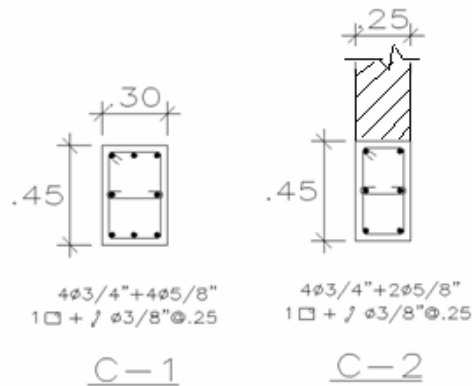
Detalle de columnas de concreto reforzado (Edificio 780 pre NDSR-1997)
